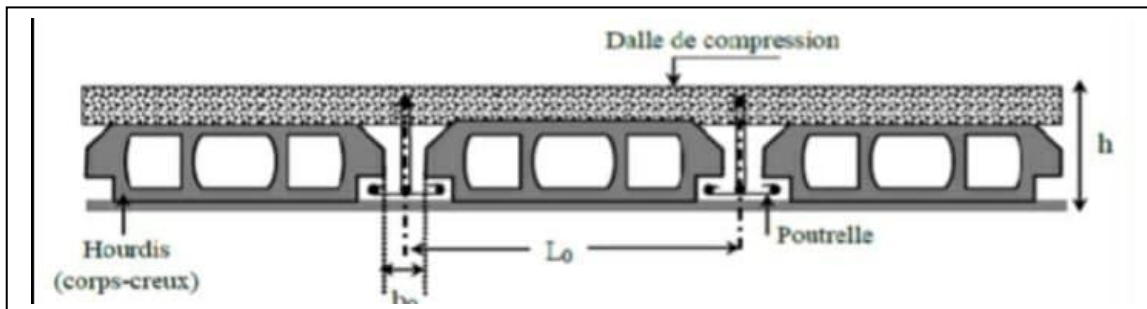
Coupe transversale sur un plancher à corps creux.
